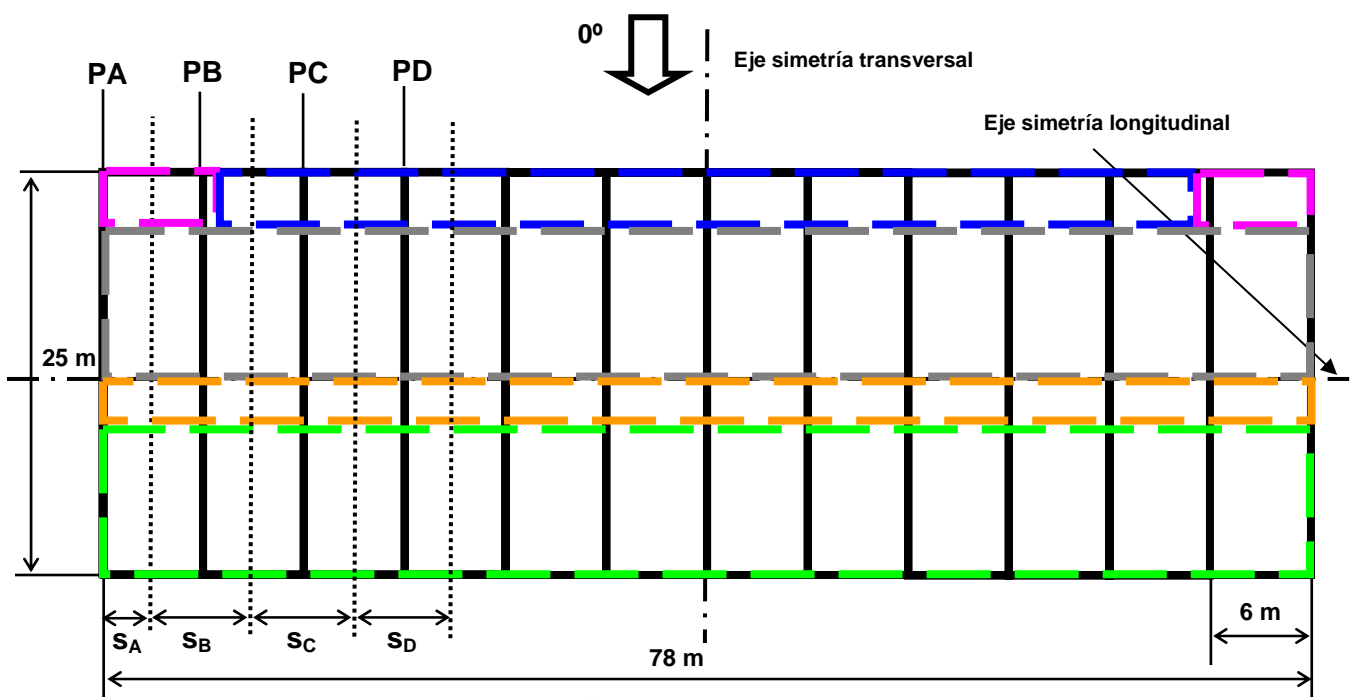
Planta de Pórticos y cubierta cuando sopla a 0°.
